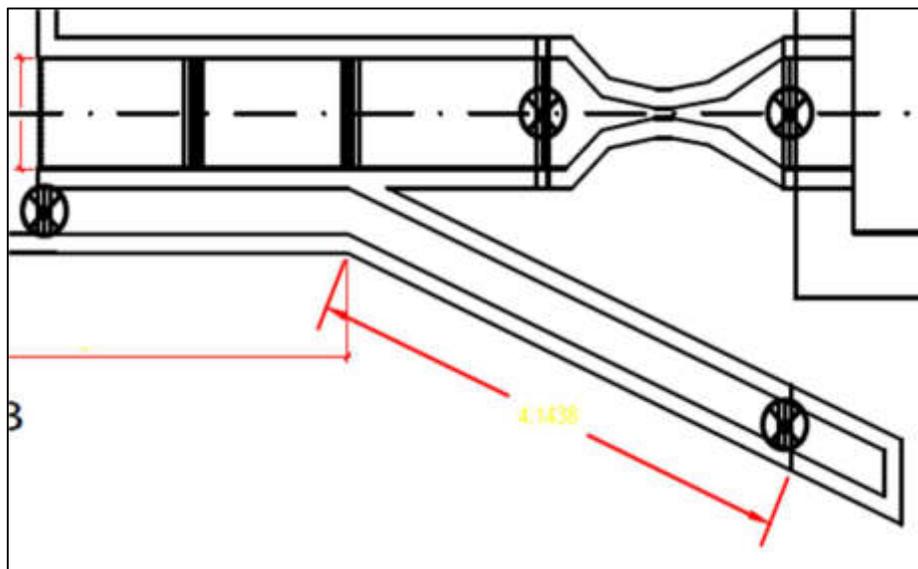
Vista en planta de Cámara de Desbaste y Canal de Parshall
